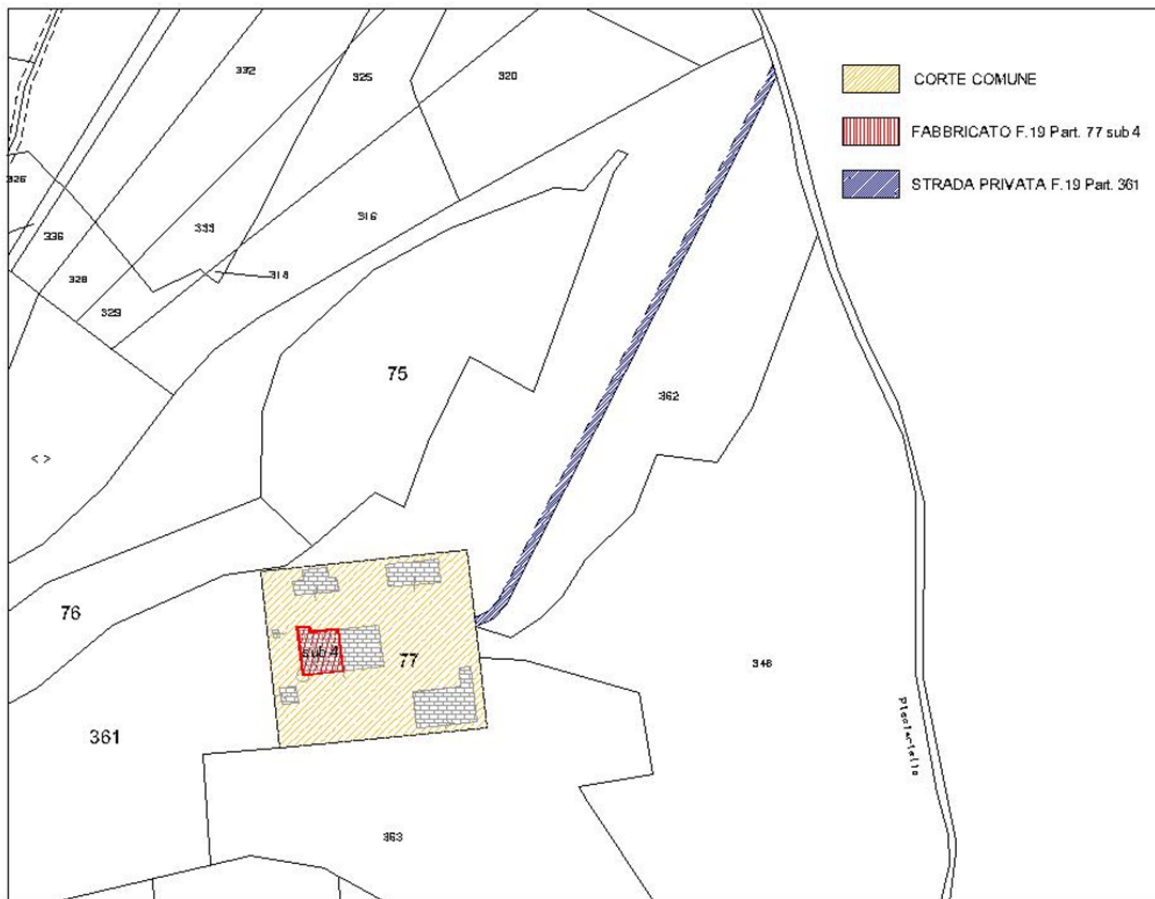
Ubicazione della strada privata di accesso alla corte comune e agli immobili: planimetria
